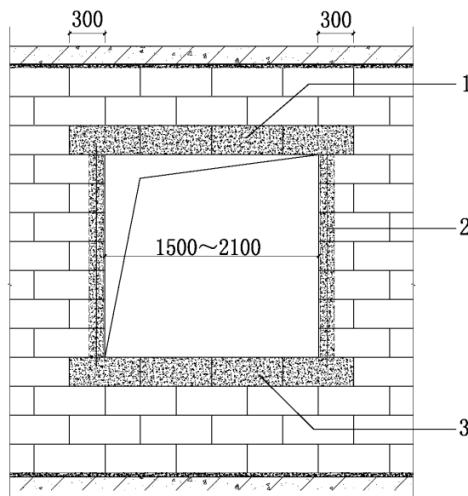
GT 高精度模块墙体窗洞口做法示意图
